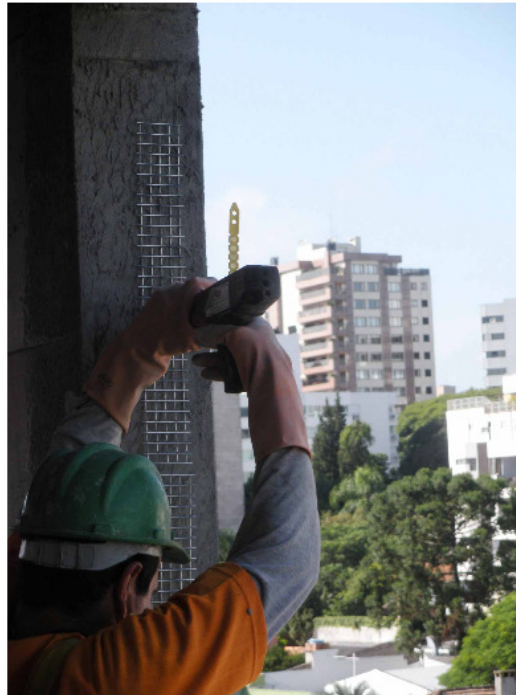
Aplicação da tela metálica galvanizada para ancoragem do pilar a alvenaria
